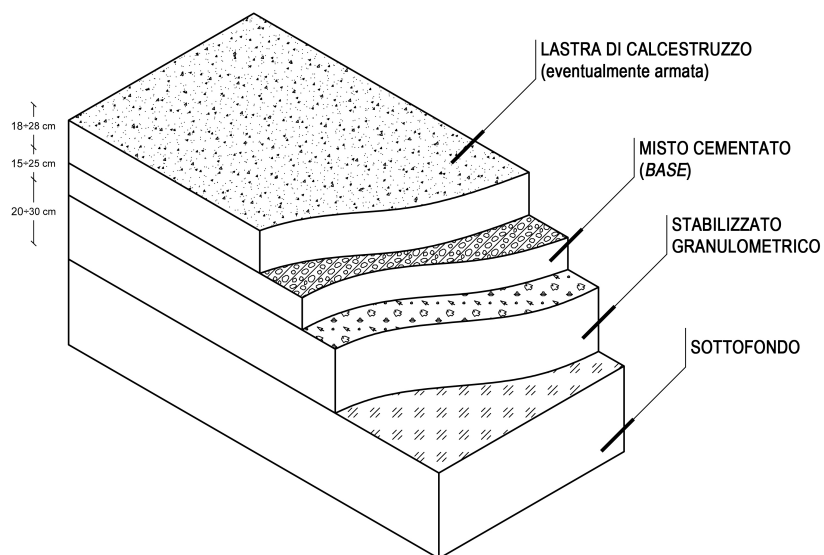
Sezione di una pavimentazione stradale rigida
